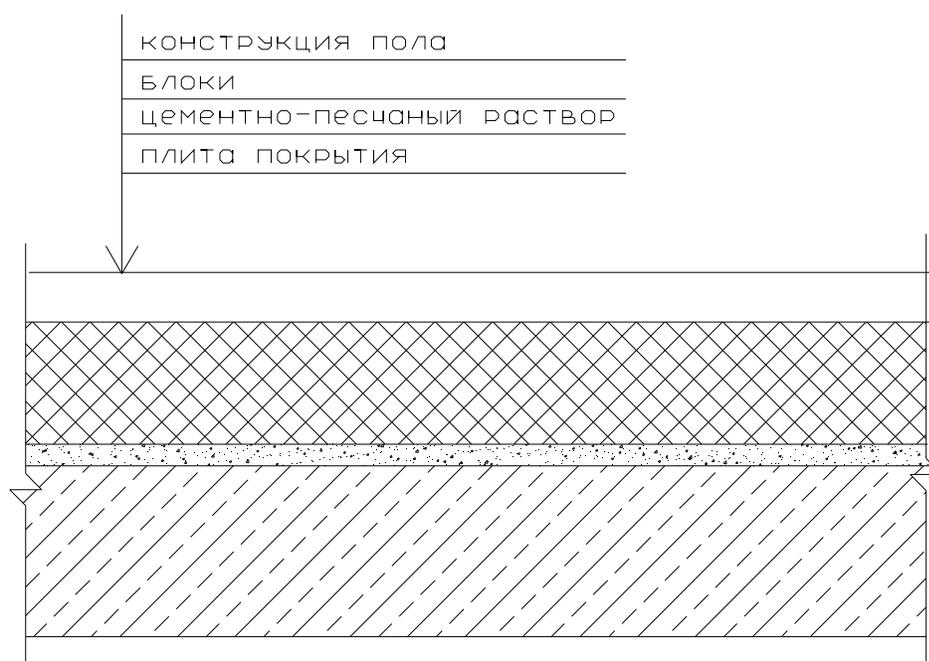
Тепловая изоляция эксплуатируемого чердачного перекрытия
